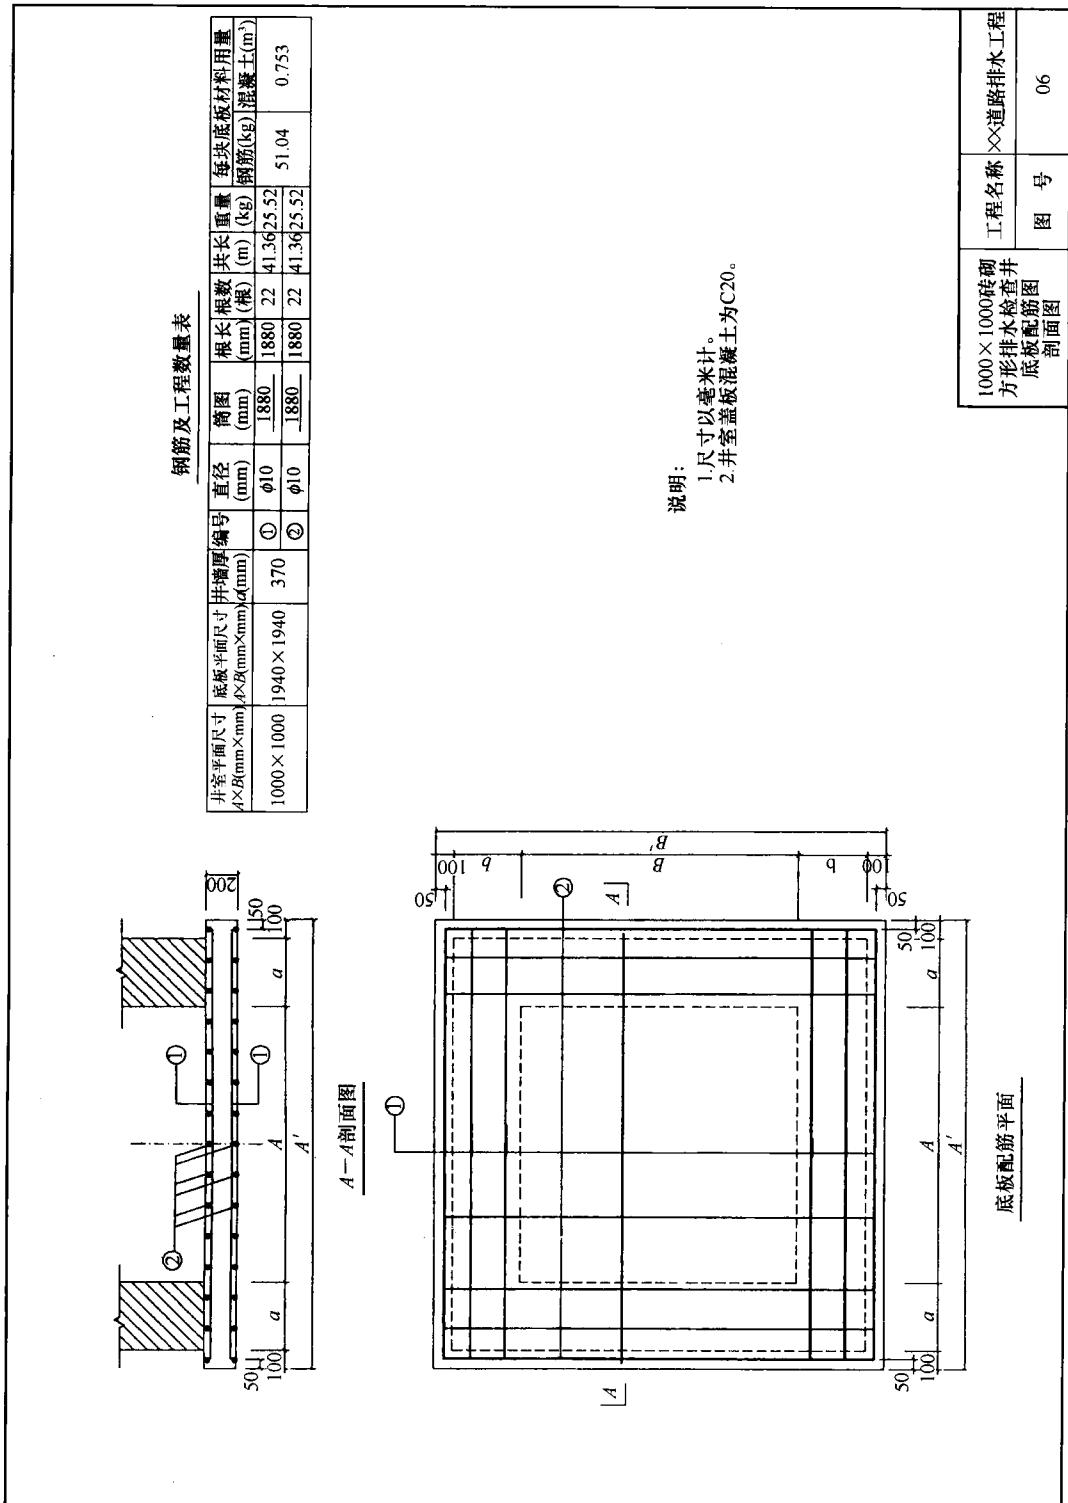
砖砌方形排水检查井底板配筋图、剖面图
